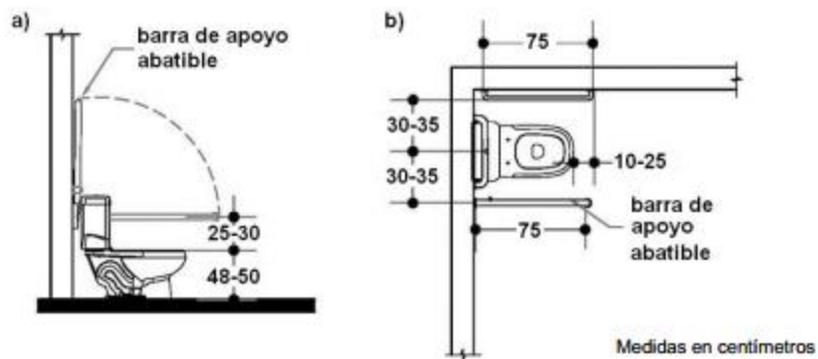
Literal a, vista en elevación lateral y literal b, vista en planta donde se grafican las tres barras de apoyo a ambos lados y en la parte posterior del inodoro con sus medidas. Fuente: CONAIPD
